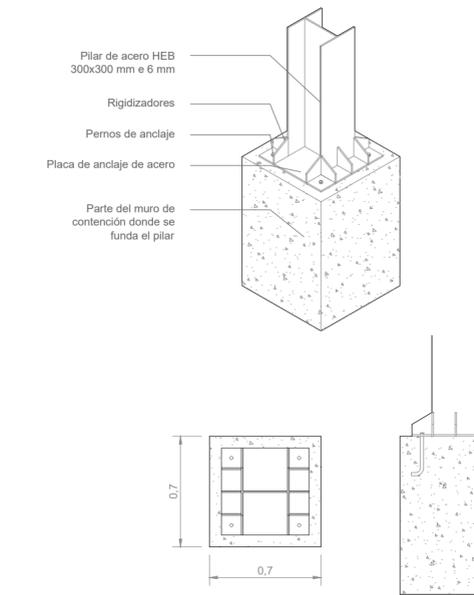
Fundación del pilar HEB en Muro de contención Fuente: Elaboración propia
